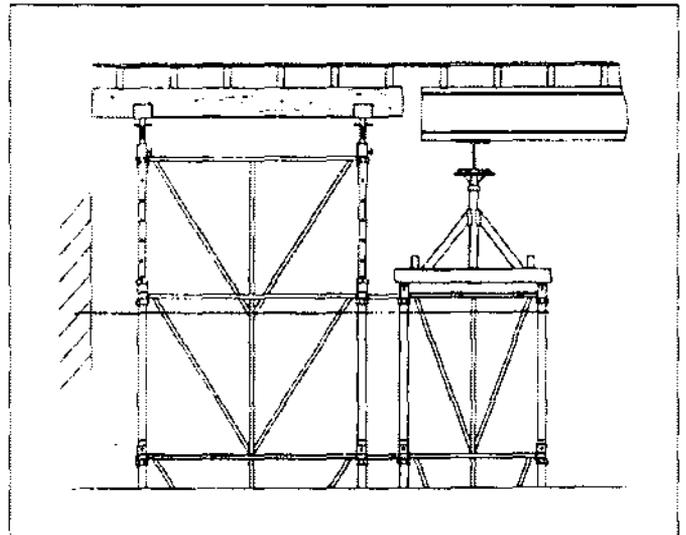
Détail 2 : appui avec bipodes sur palée.
